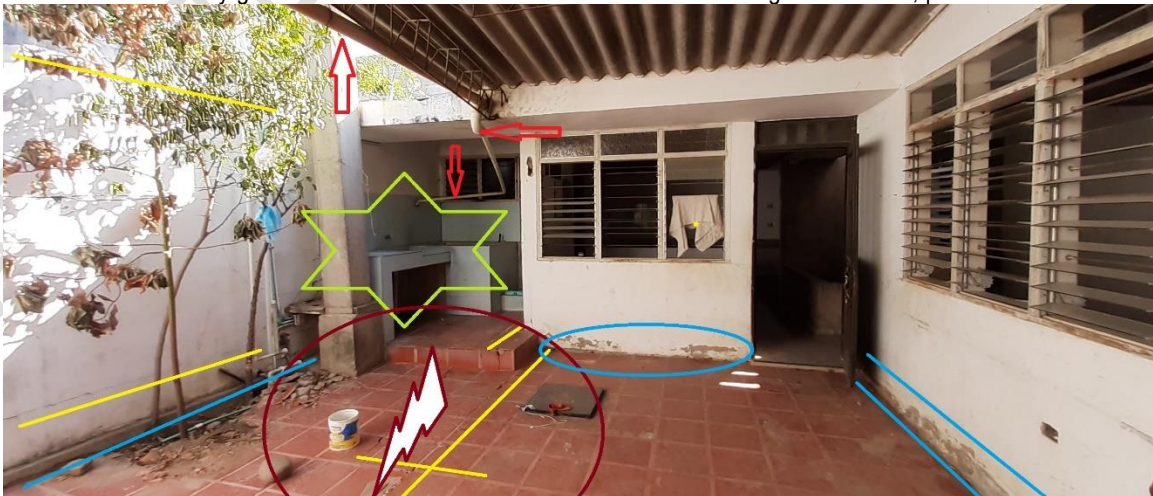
Vista interna del patio y area de labores, estado actual, referencias de patologías, como: fisuras, grietas, fracturas de elementos estructurales y no estructurales, agrietamiento de pisos, presencia de humedades, entre otras.
